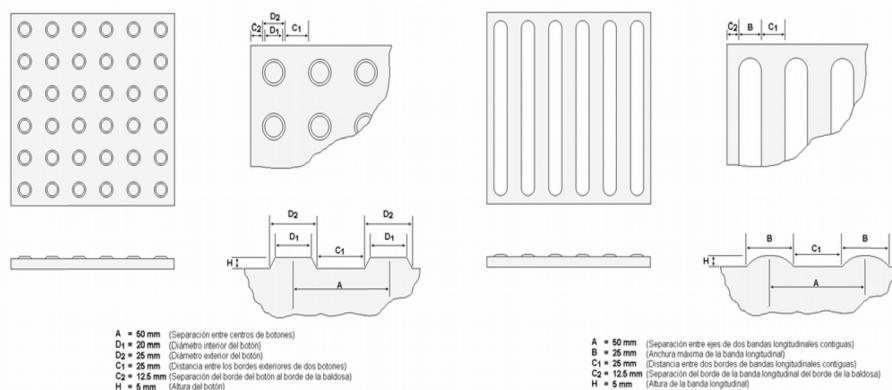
Pavimentos. Detalle de baldosa podotáctil abotonada y acanalada.
